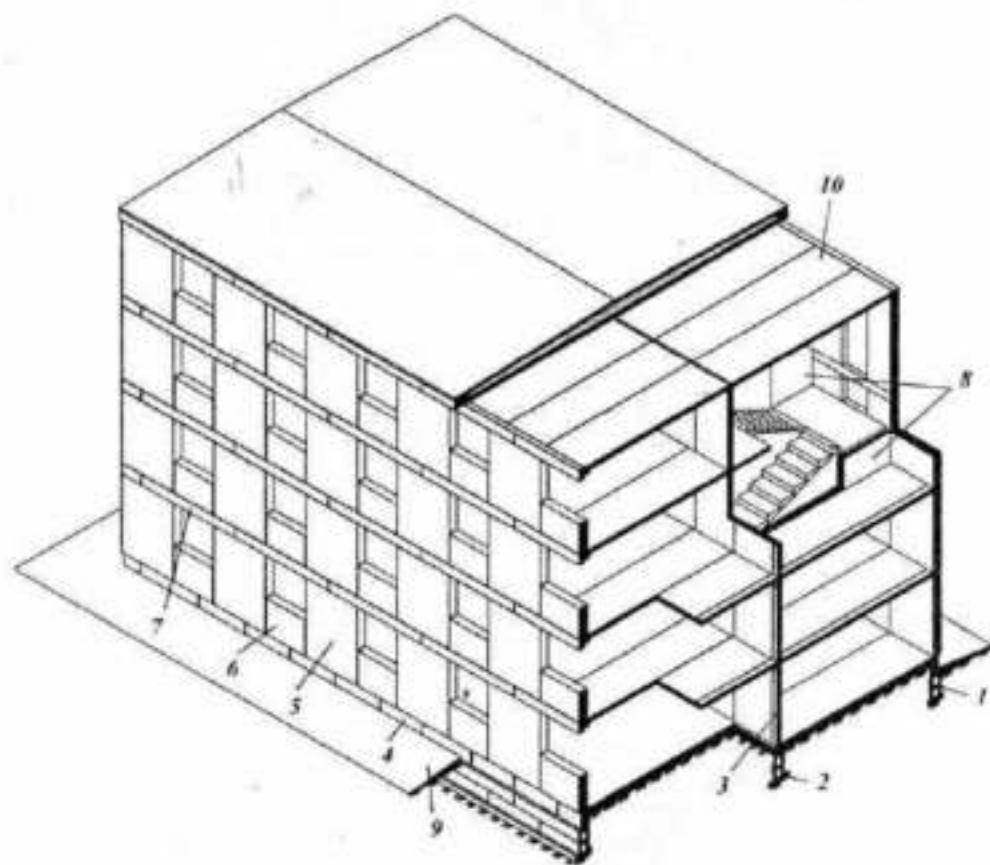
Багатоповерховий житловий будинок великоблокової будівельної системи: 1 – стіновий фундаментний блок; 2 – залізобетонна фундаментна плита; 3 – блок внутрішніх стін; 4 – цокольний блок; 5 – простіночний блок зовнішніх стін; 6 – підвіконний блок зовнішніх стін; 7 – перемичковий блок зовнішніх стін; 8 – блоки стін сходової клітки; 9 – вимощення; 10 – плита перекриття
